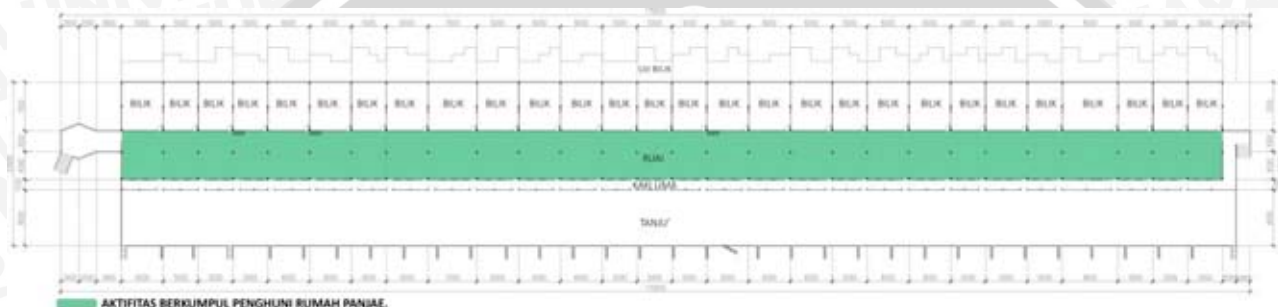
Isometri pembentuk ruang bersamsa di ruang *Ruai*.
